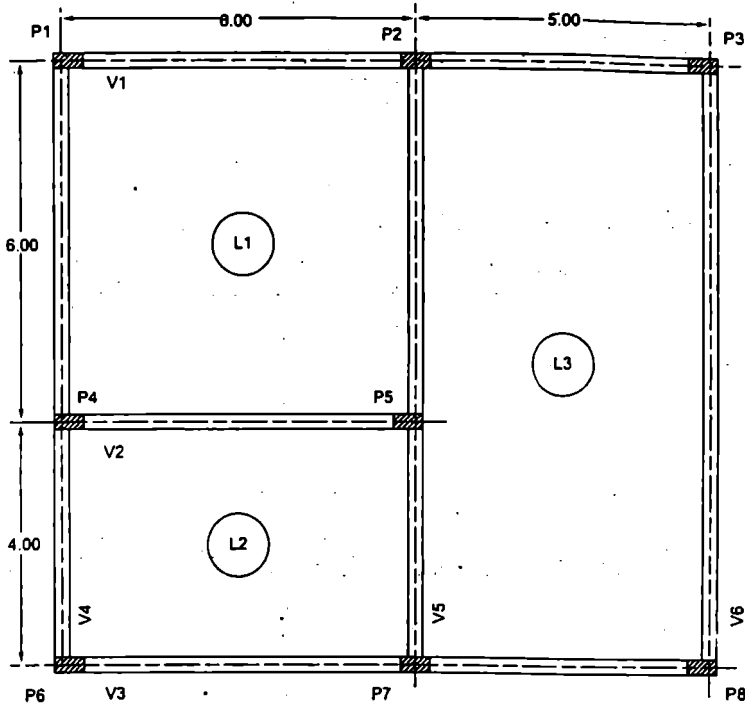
Planta de fôrmas do pavimento do exemplo 1.
